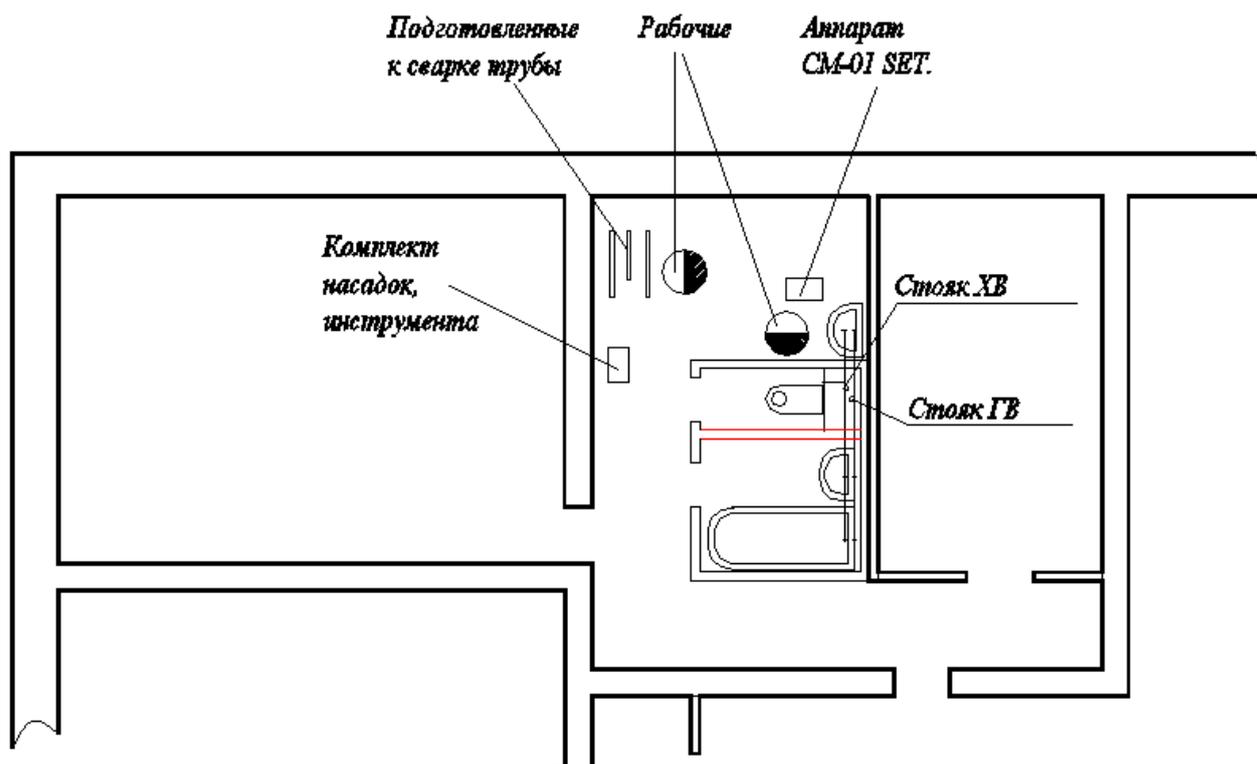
Схема рабочего места сварки стыков трубопровода
